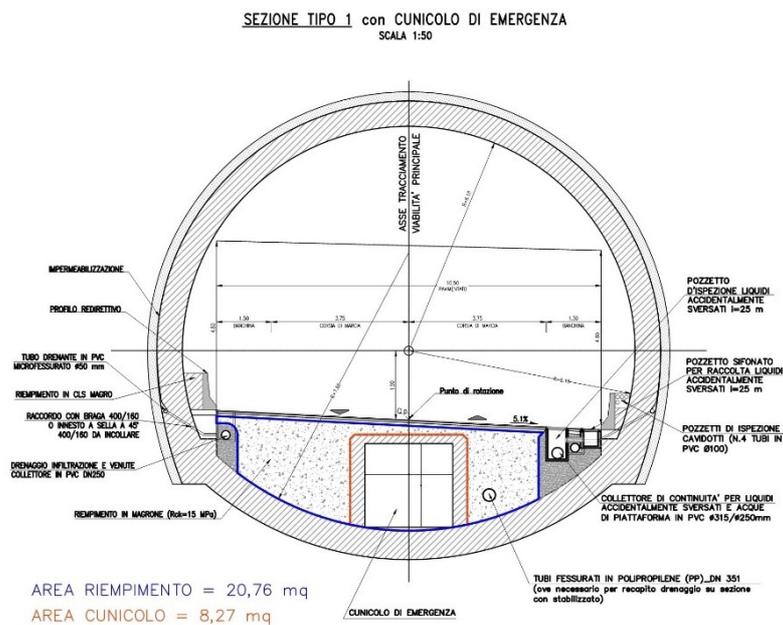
Sezione tipo galleria naturale con cunicolo di emergenza
